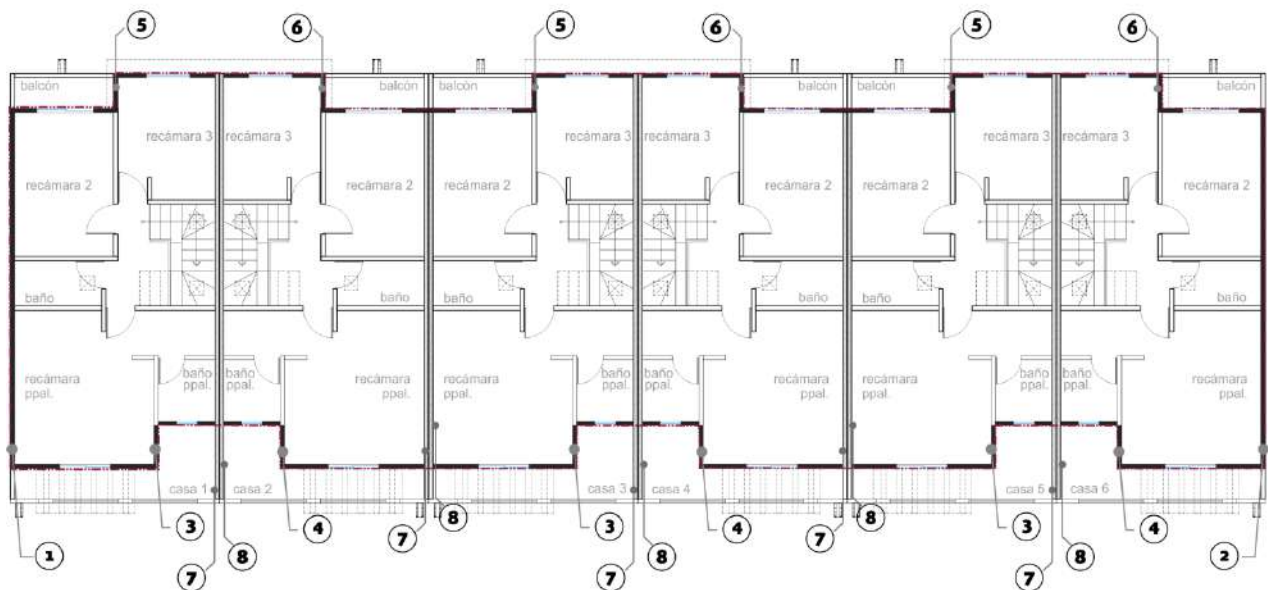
Planta de viviendas en conjunto horizontal.
